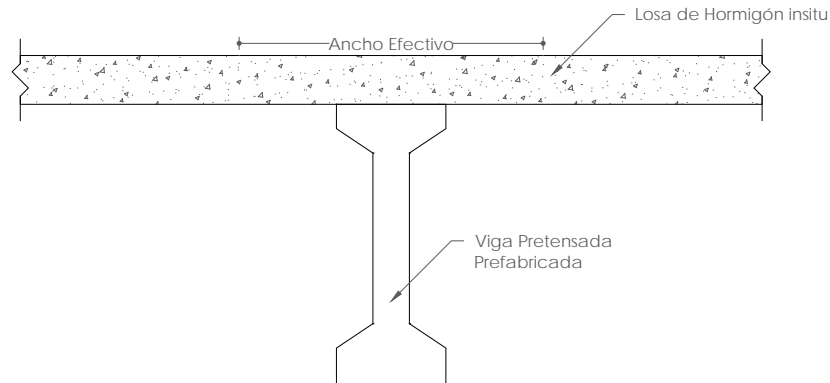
Ancho efectivo de una viga de sección compuesta
